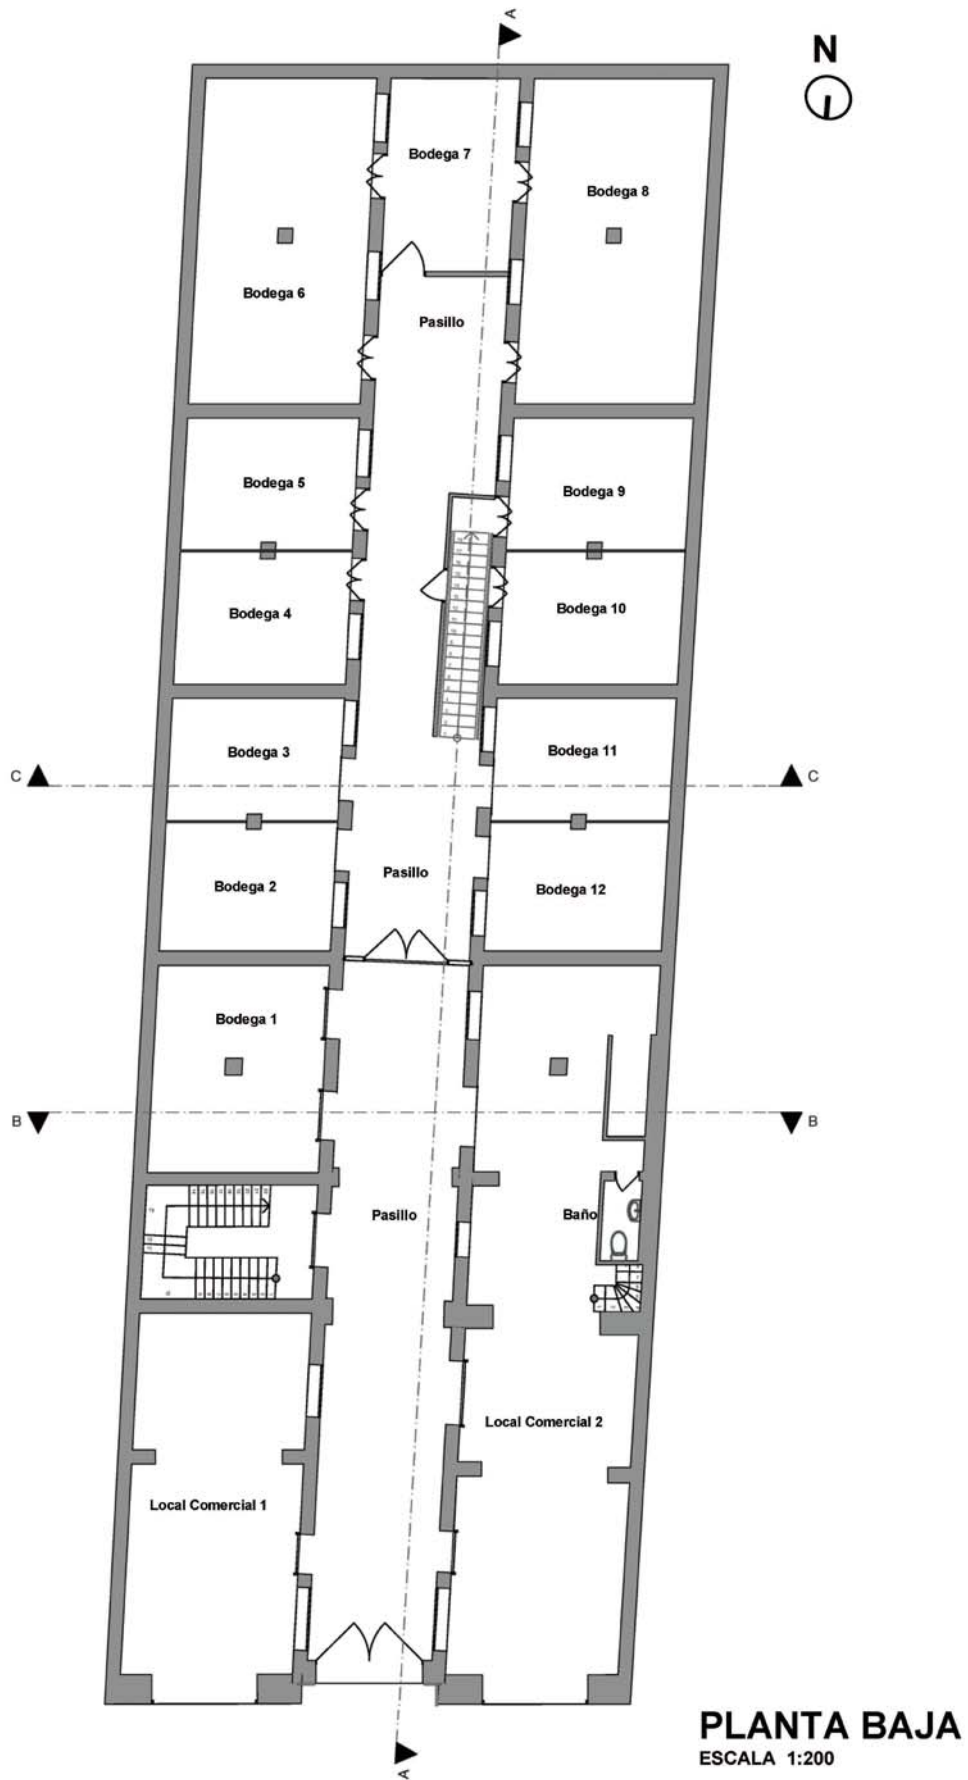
Redibujo de planta baja de Pasaje León previo a intervención de restauración 2009.
